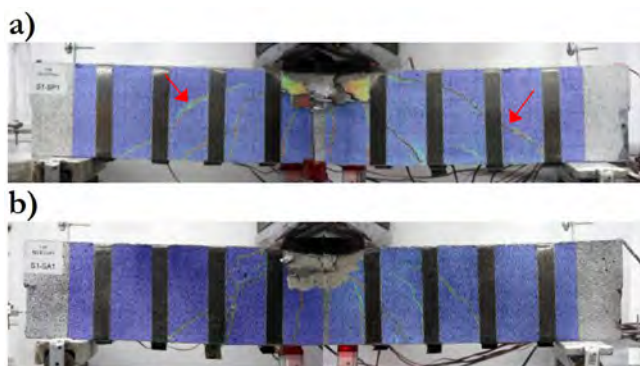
Fisuración de las vigas justo después de la carga máxima. a) Viga SP1: flejes de 25 mm sin activación. b) Viga SA1: flejes de 25 mm activados.
